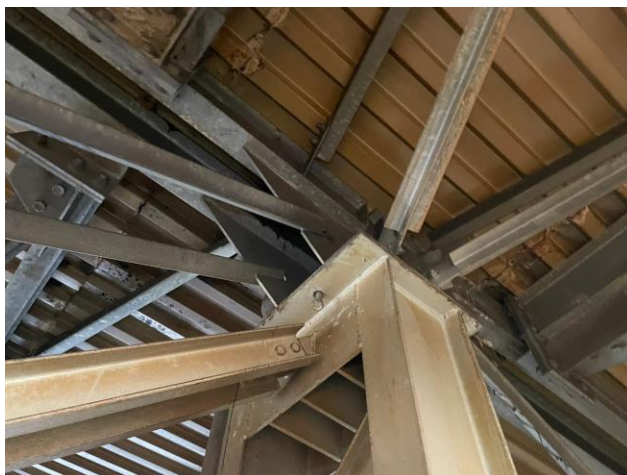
Узел опирания конструкций покрытия на оголовки колонны К2. Ослабленное состояние болтов.
